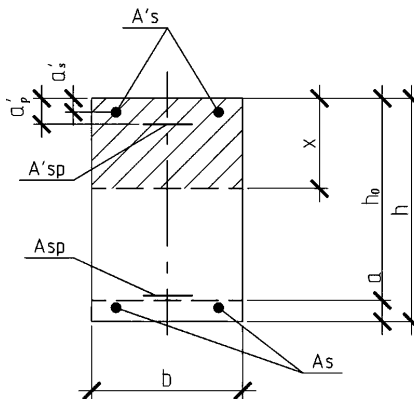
Поперечное прямоугольное сечение изгибаемого железобетонного элемента
